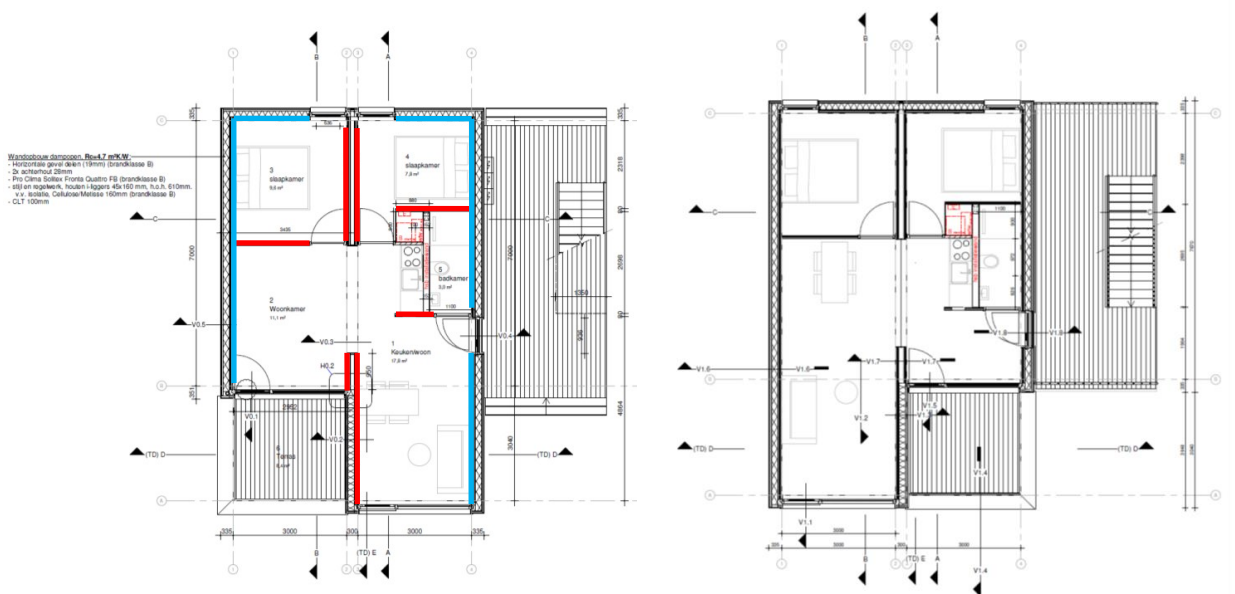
overzicht constructie losse units (links) en samengesteld appartementengebouw (rechts)
